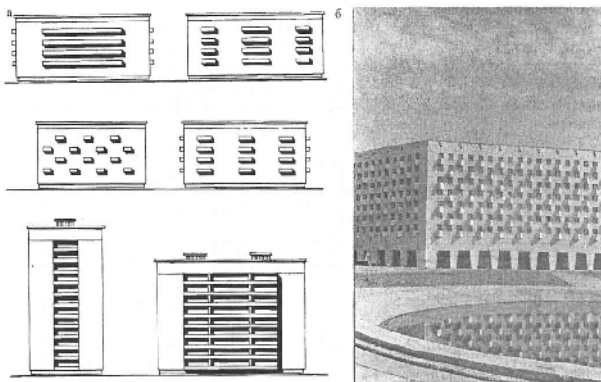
Схемы: а – изменение характера и масштаба членений фасадов жилых домов за счет различной группировки лоджий помещений; б – пример мелкого членения фасада жилого дома балконами (Архангельск)
